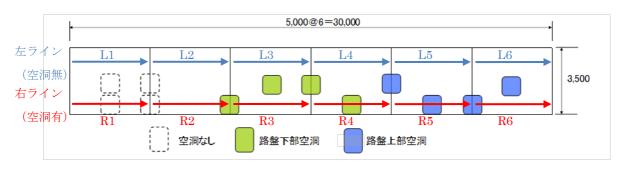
試験ヤード平面図 (緑:路床直上空洞,青:Co版直下空洞)
